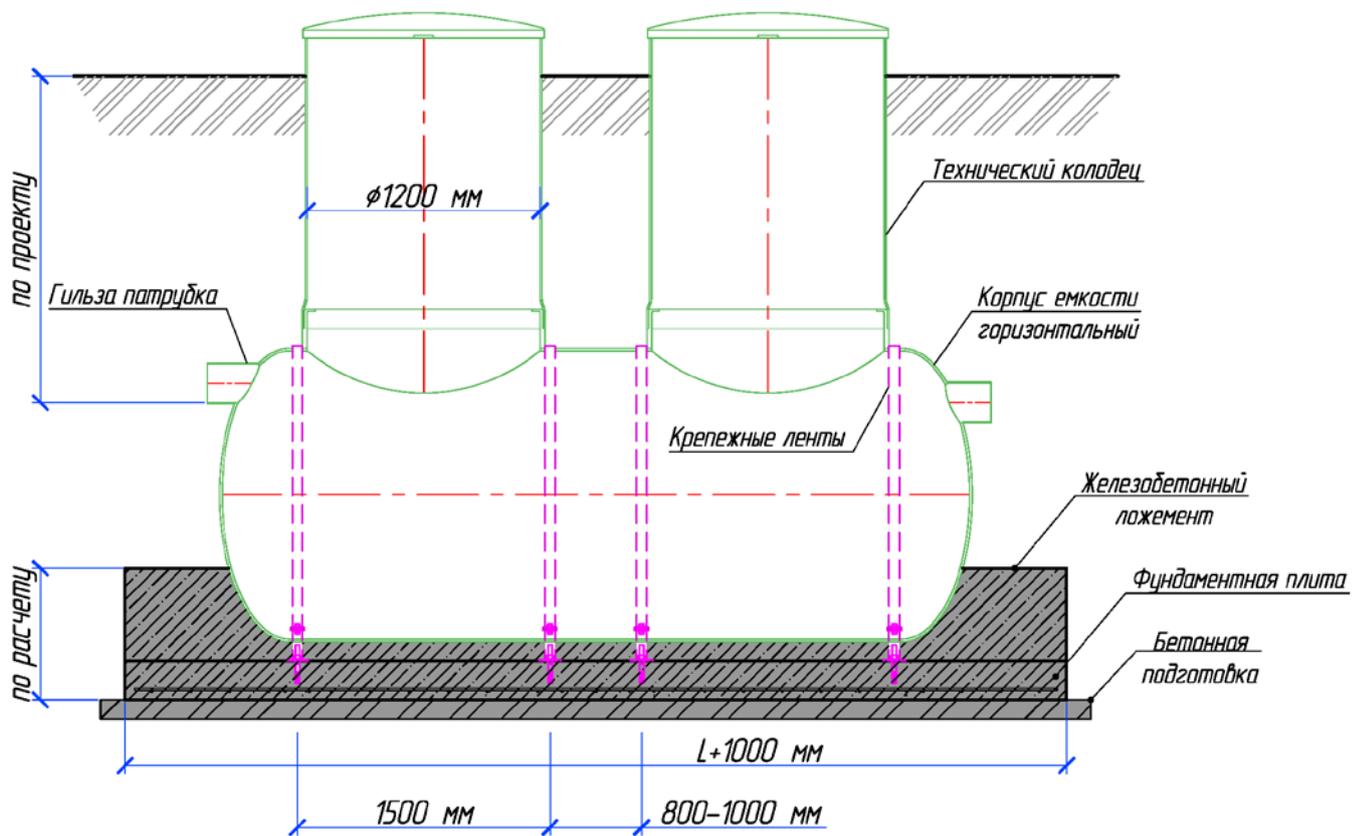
Крепление горизонтального изделия к фундаментной ж/б плите
